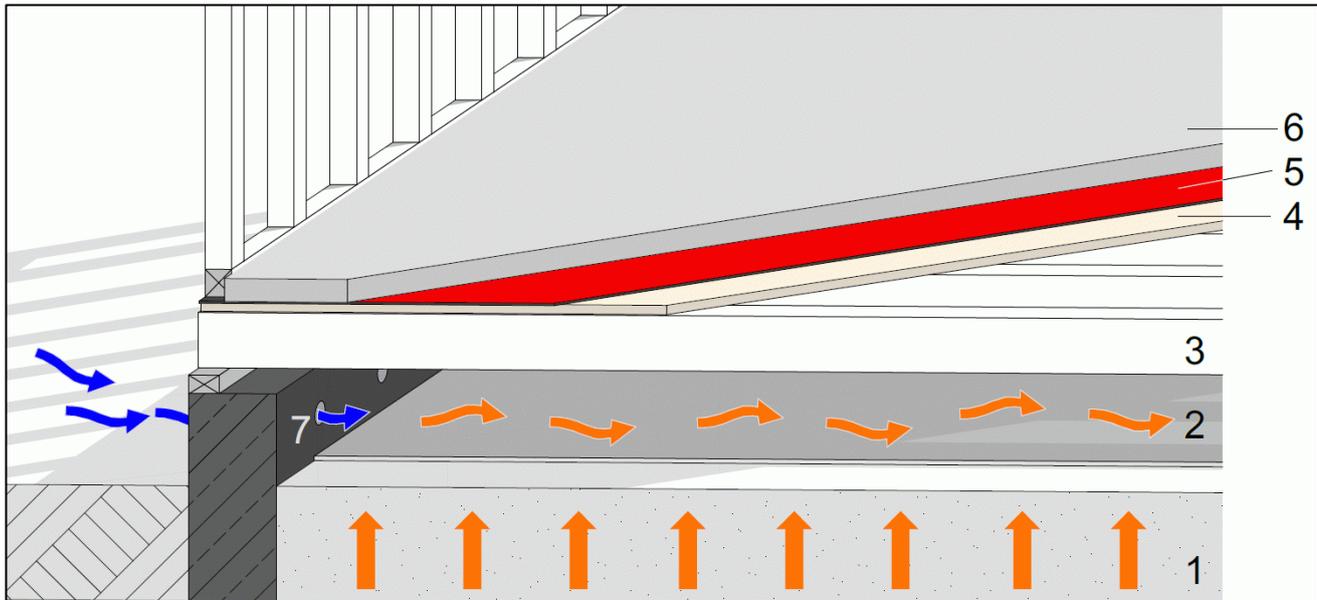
Schematische Darstellung Holzbaueise mit Kriechgang
